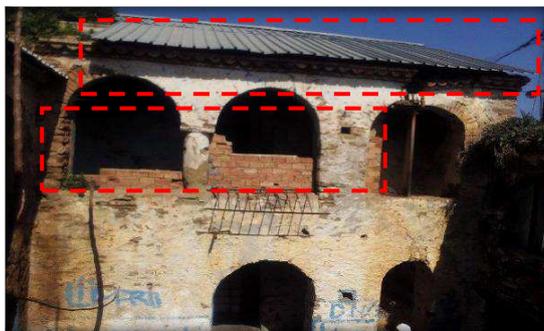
Intervention sur l'existant par de nouveaux matériaux (brique, mortier et tôle...)
